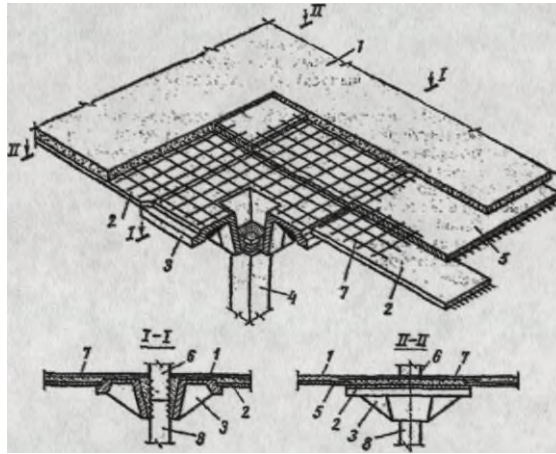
Конструкція збірно-монолітного безбалочного перекриття, запропонованого ПВІ: 1 - бетон замонолічування; 2 - міжколонна плита з попередньо напруженою дротяною арматурою (струнобетонна плита); 3 - фасонна ребристостаканна капітель; 4 - нижня колона; 5 - струнобетонна прогонова плита; 6 - верхня колона; 7 - зварна сітка ненапруженої верхньої арматури над опорами; 8 - колони нижнього поверху
